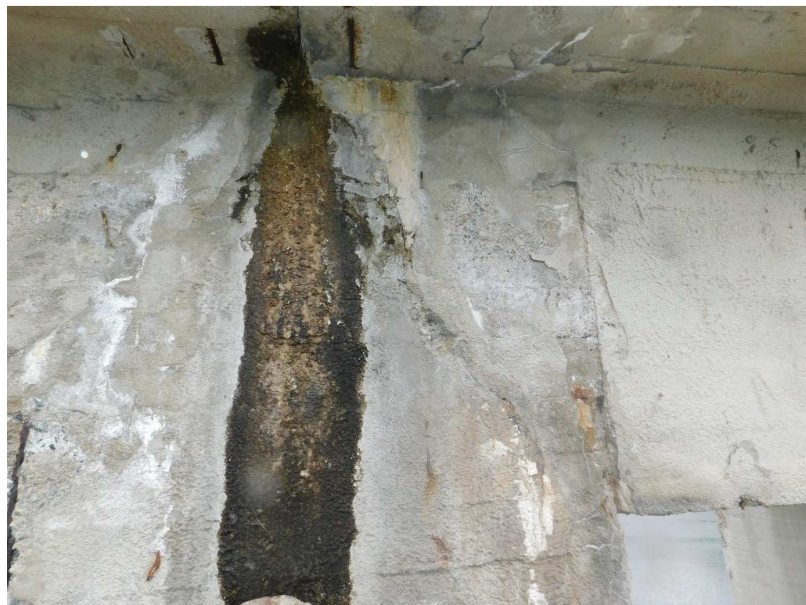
pole 11, silné průsaky úložným prahem pilíře P11, levá strana
